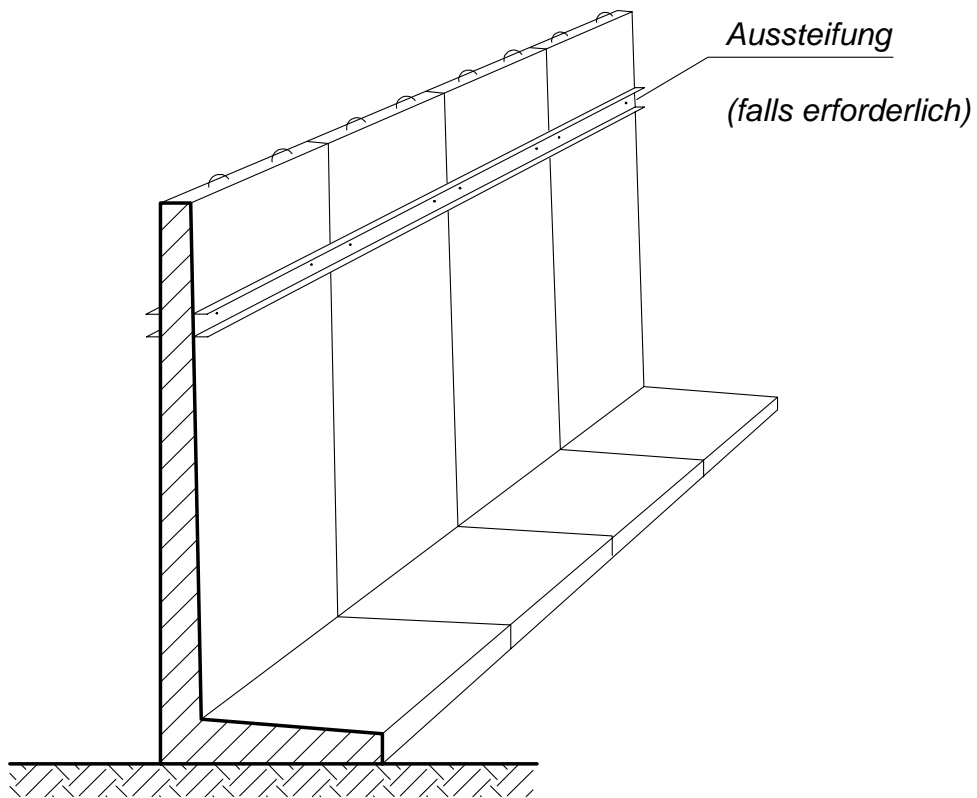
Stützwand aus Betonfertigteilen (L - Elemente)
